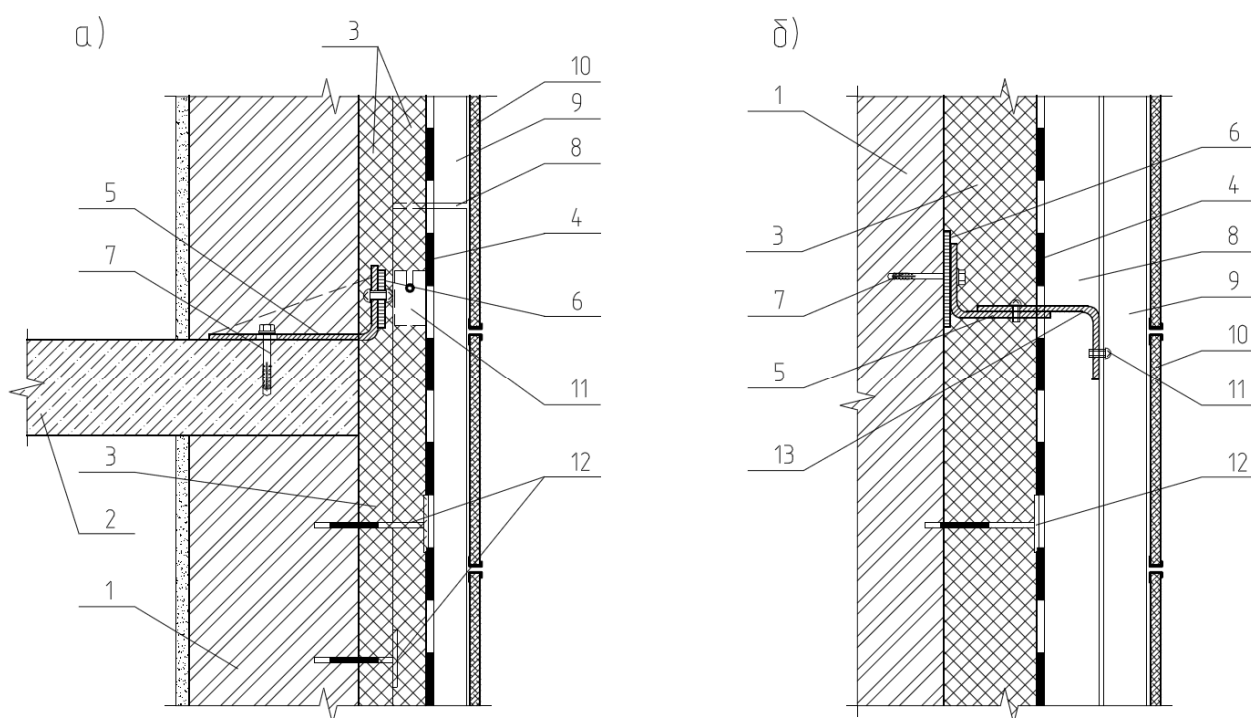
Конструктивная схема фасадной теплоизоляции с вентилируемой воздушной прослойкой:
